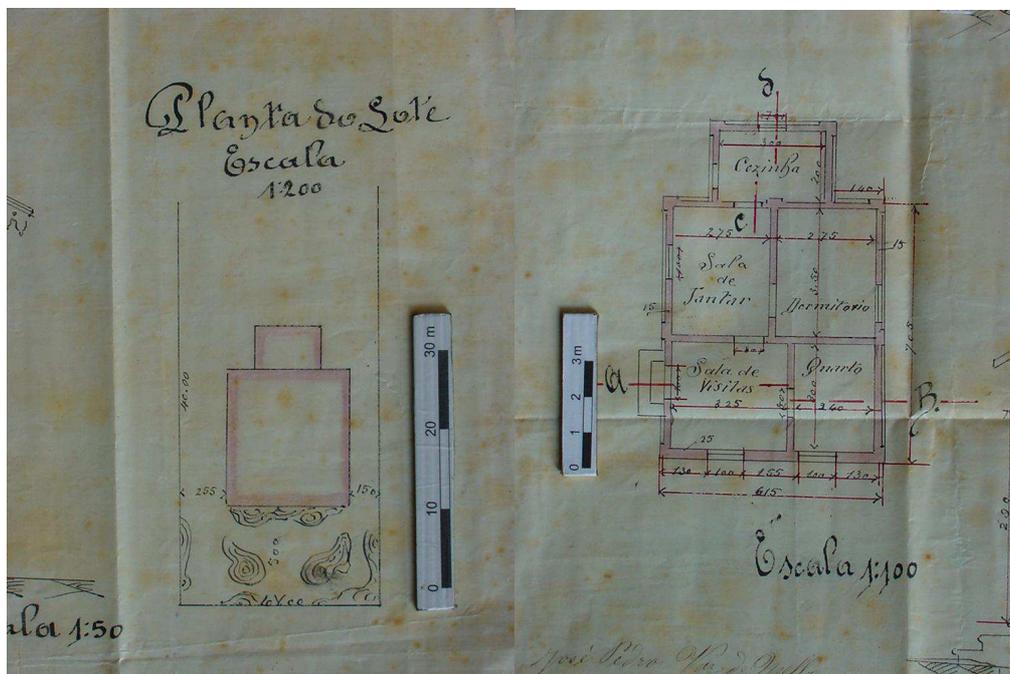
Plantas do projeto de Luiz Olivieri referente à construção erigida na Avenida do Contorno no ano de 1906. Lote 64, Quadra 1C, Seção 14. Acervo: APCBH. Foto: NORONHA, Carlos Roberto. Pesquisa de projetos de arquitetura na área central de Belo Horizonte.
